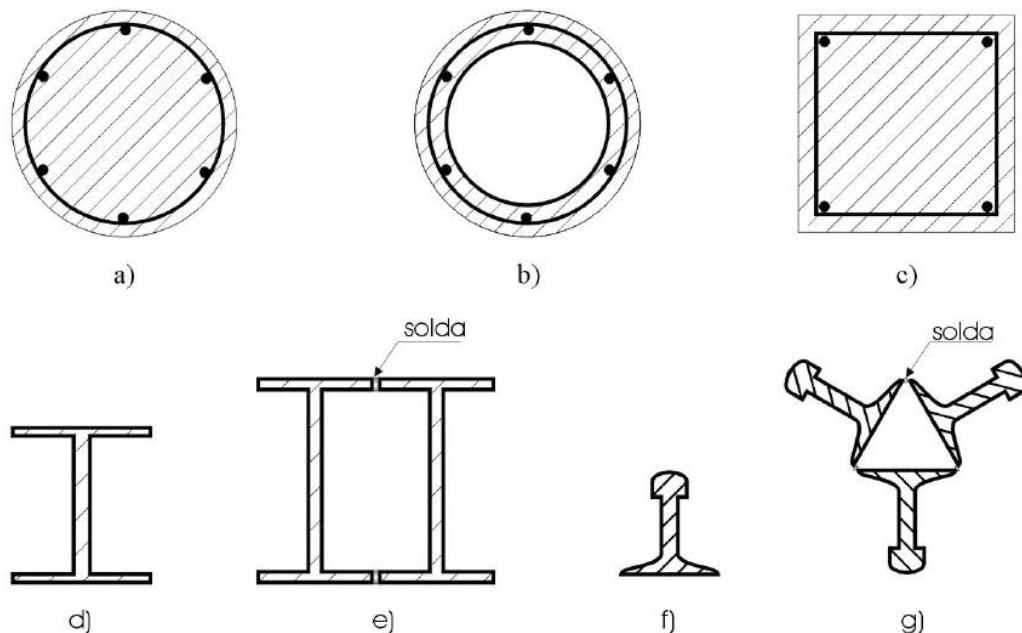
Secções transversais de estacas :a) estaca circular de betão; b)estaca circular oca de betão; c) Estaca quadrada de betão; d) Perfil metálico H ou I; e) Perfil metálico duplo I; f) Carril simples; g) perfil formado por três carris soldados.(Vitório, 2002)
